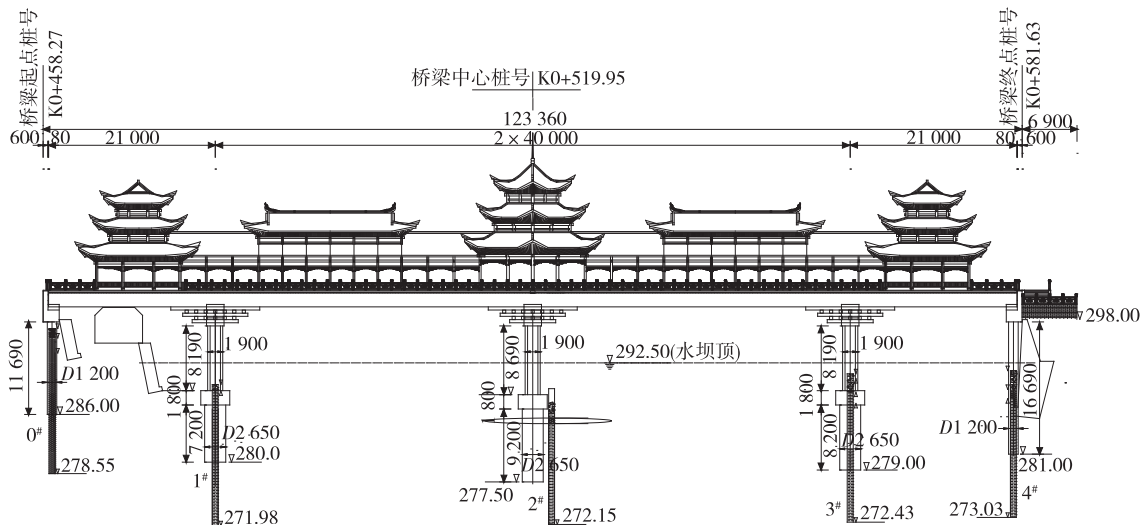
绥宁县民族风雨桥立面布置(单位:高程为 m,其他为 mm)
